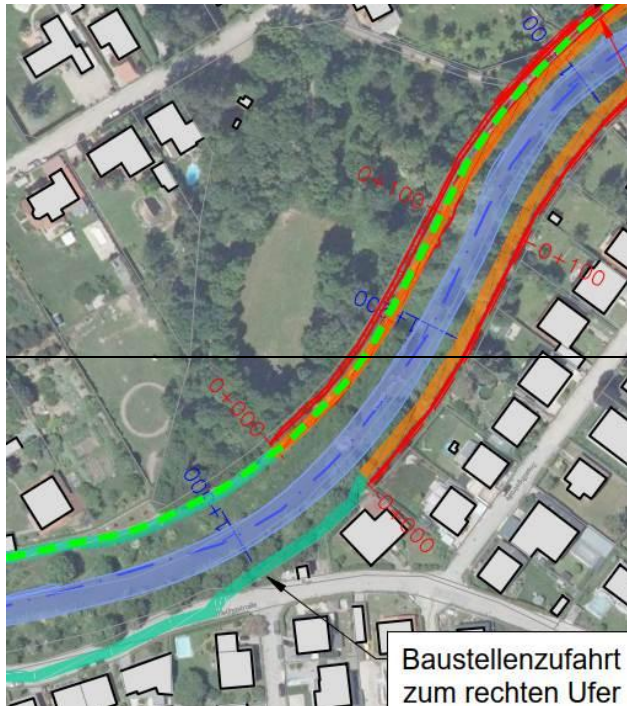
Radlpark Trumau, Ausschnitt Übersichtslageplan Baustellenkonzept BA04 Teil 01 (Quelle: Einreichoperat, Einlage 266)
